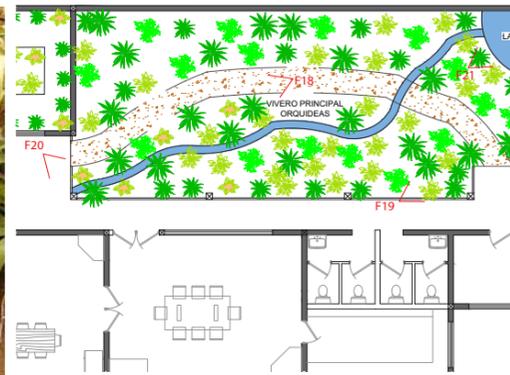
PLANTA DE VISTAS DEL VIVERO GENERAL
